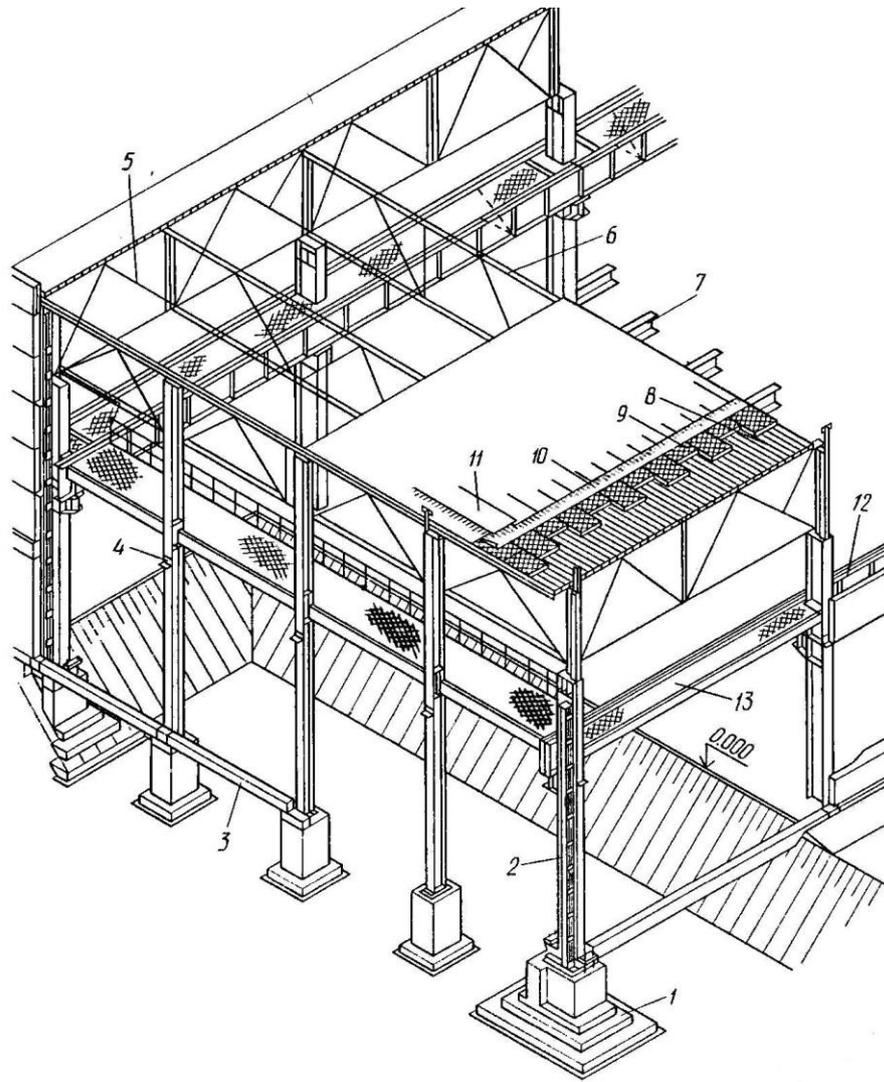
Стальной каркас одноэтажного промздания со стропильными и подстропильными фермами:
